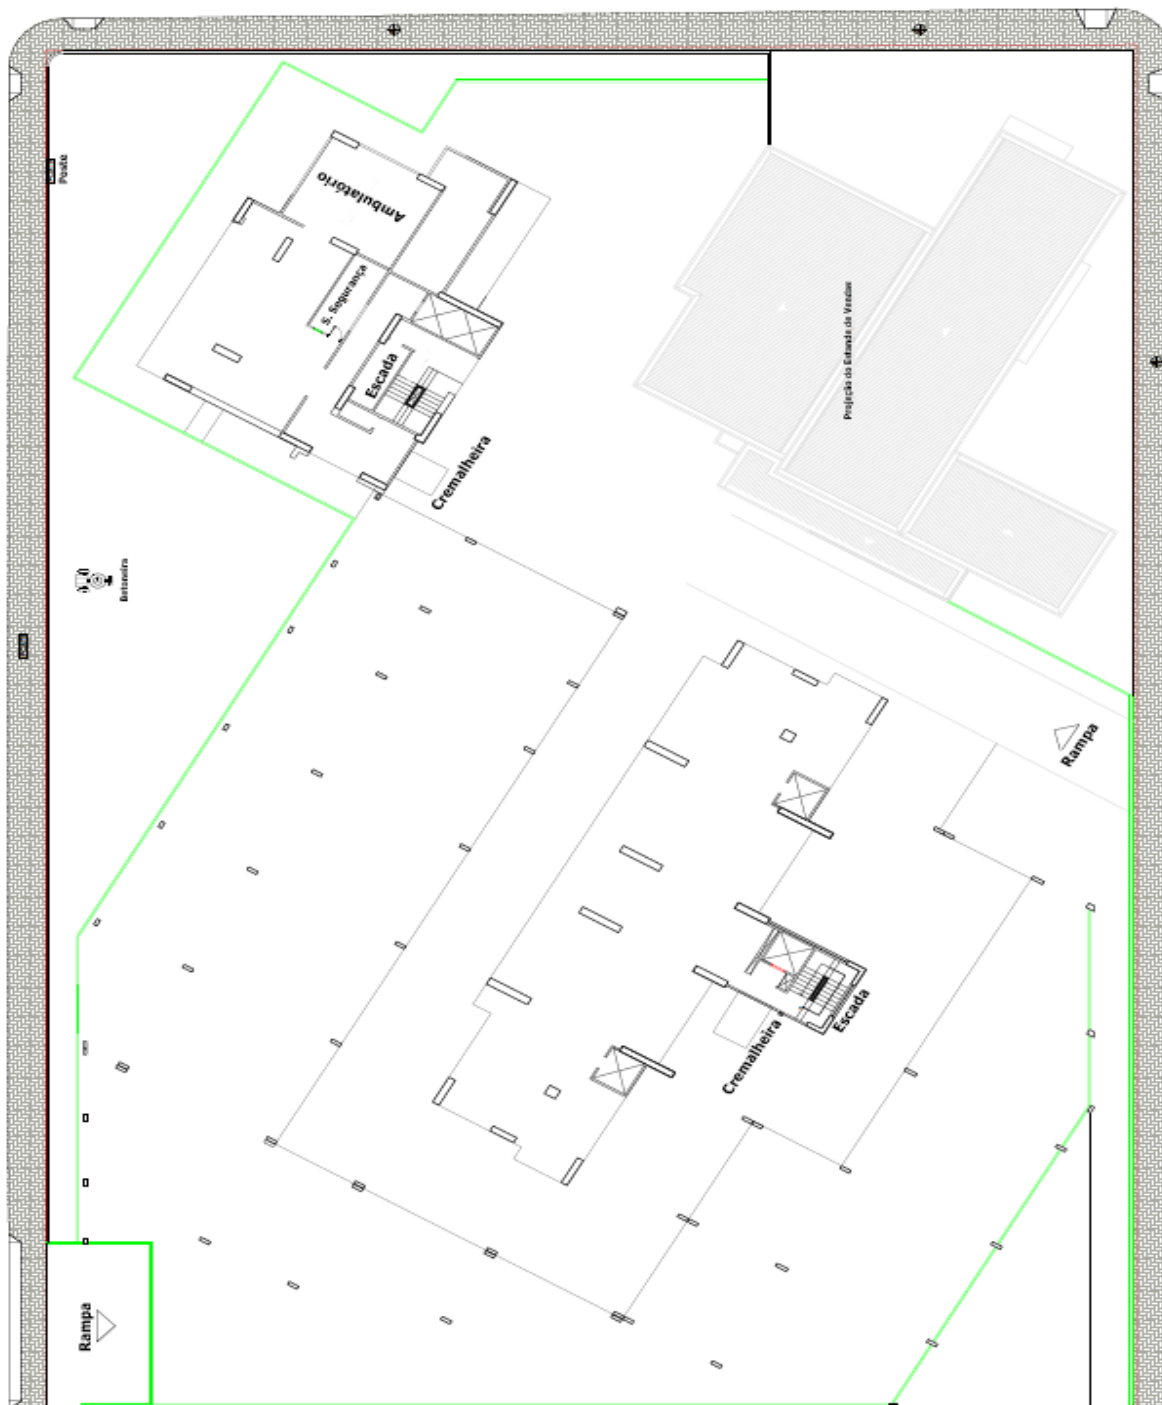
Planta Baixa do Mezanino Torre A – Layout do Canteiro de Obras.
